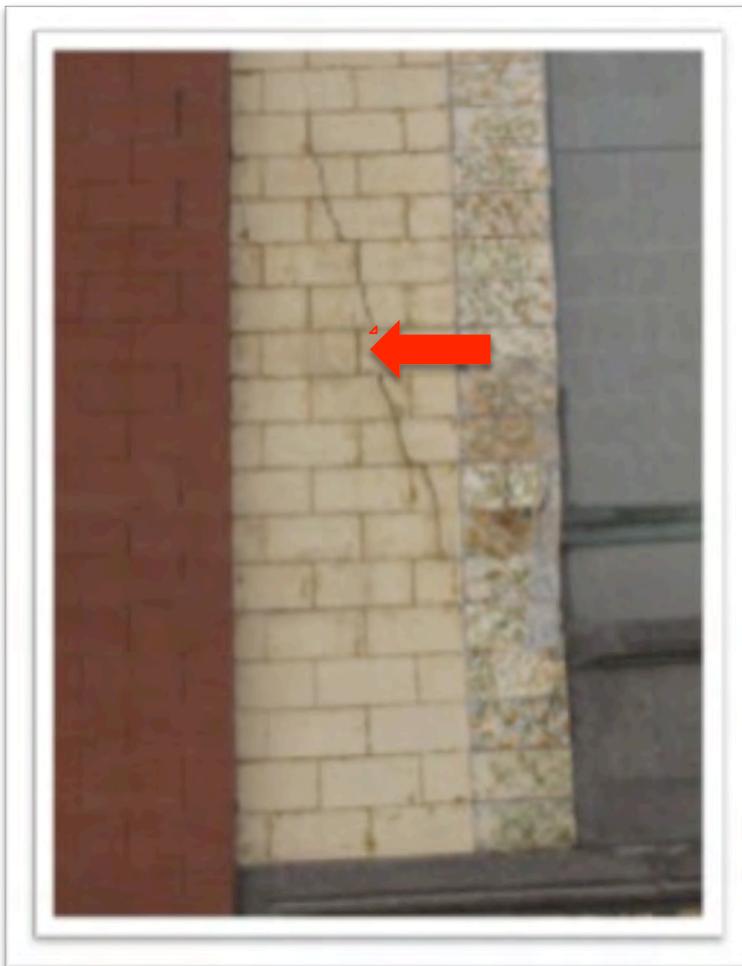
Grieta en diagonal, se localiza en fachada.
